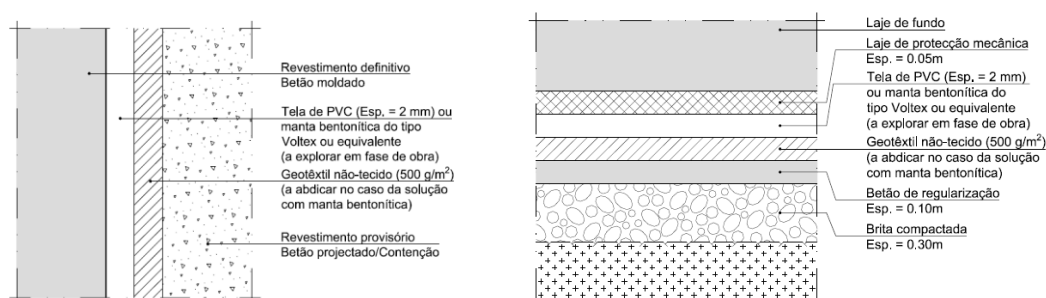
Sistema de Impermeabilização para o revestimento final de estruturas executadas a céu aberto
